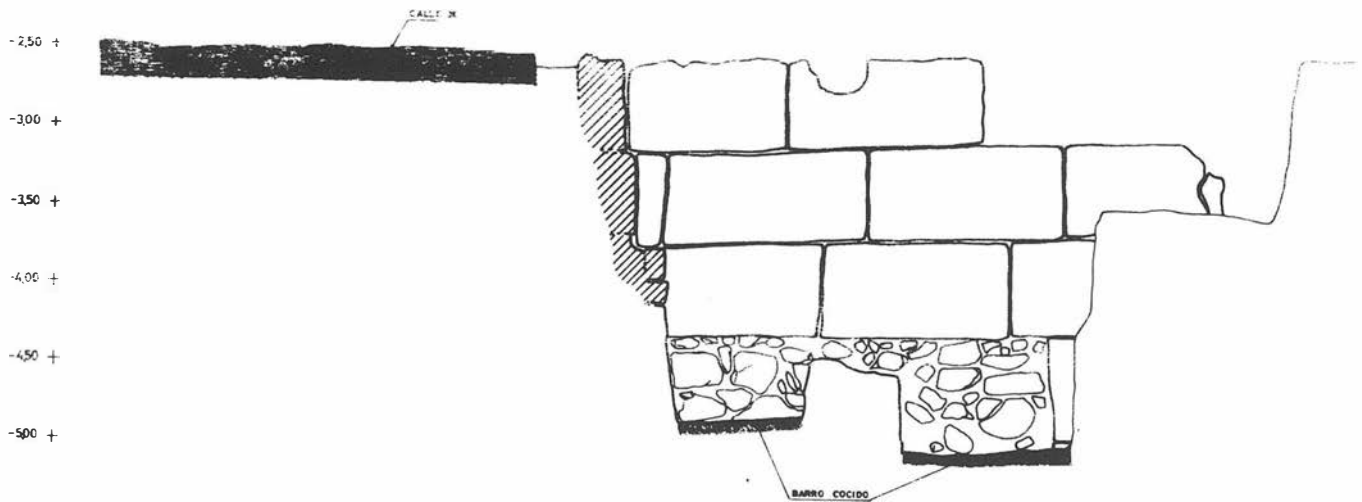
RT6. Pavimento de la calzada 2ª y alzado del muro C.
